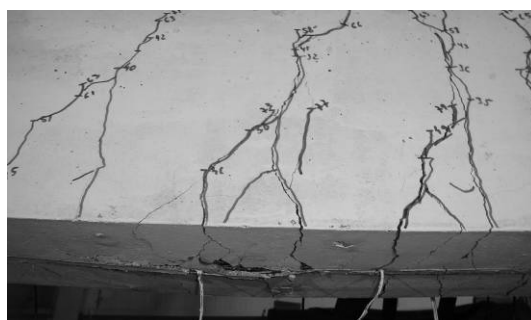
Pormenor do modo de rotura da viga S1-PC1 (rotura do laminado de CFRP).
